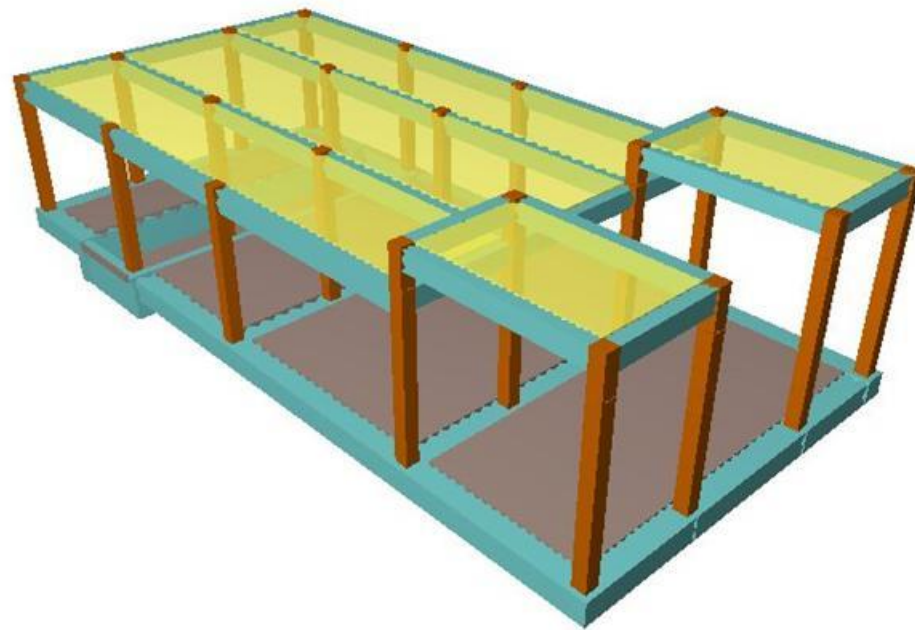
Vista 3D del modelo estructural del edificio de deshidratación
